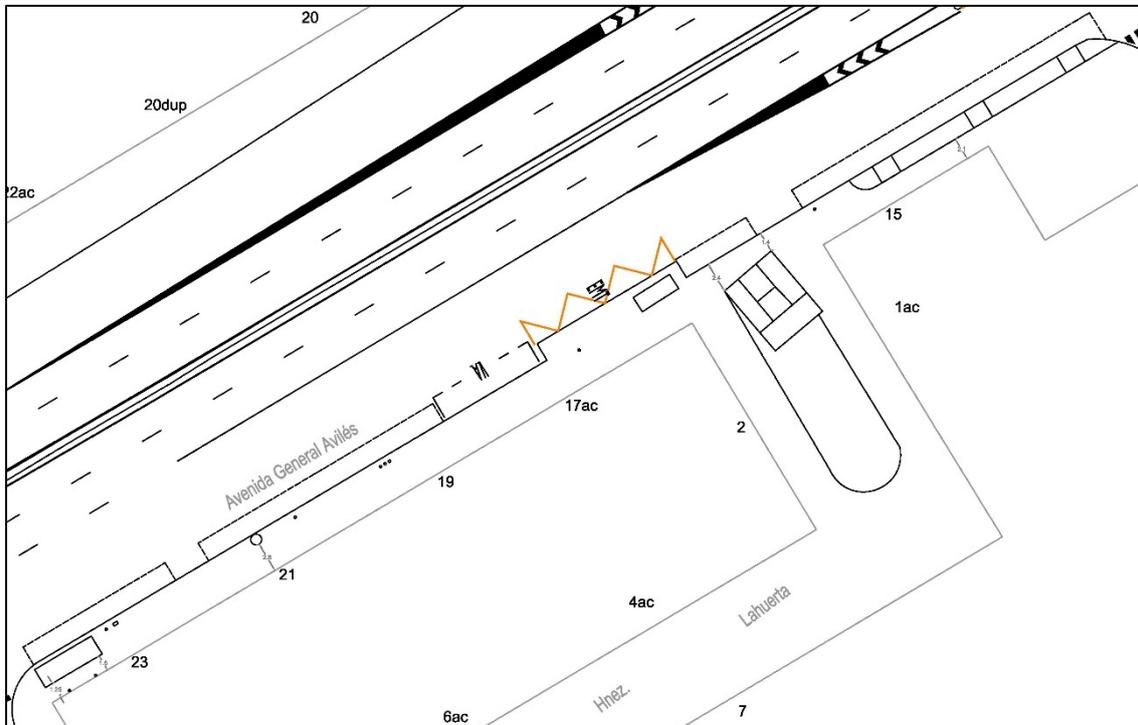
Planta de la calle. Fuente: Elaboración propia.
